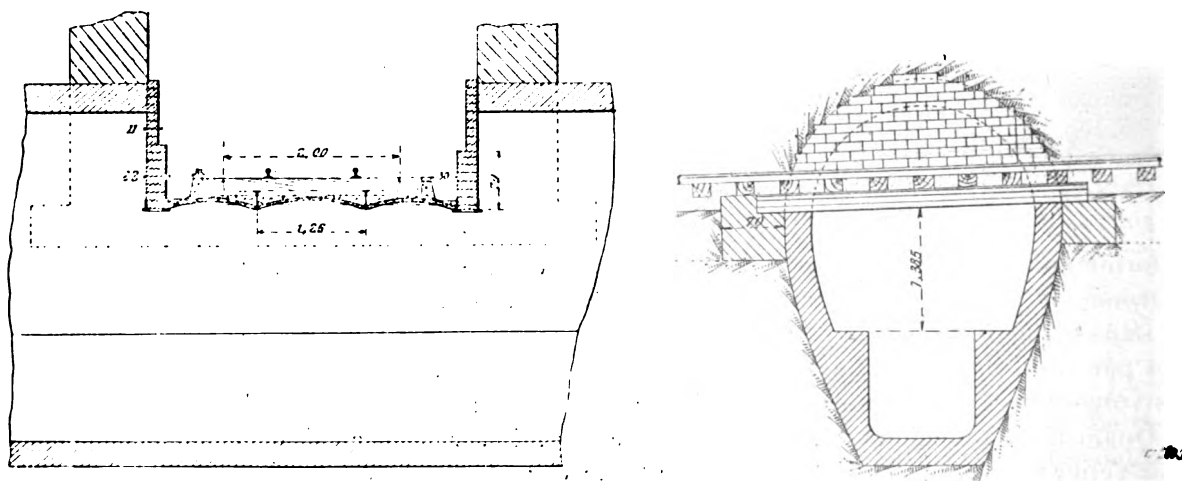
et 20. — Coupes transversale et longitudinale de la voie à la traverse d'un égout.
